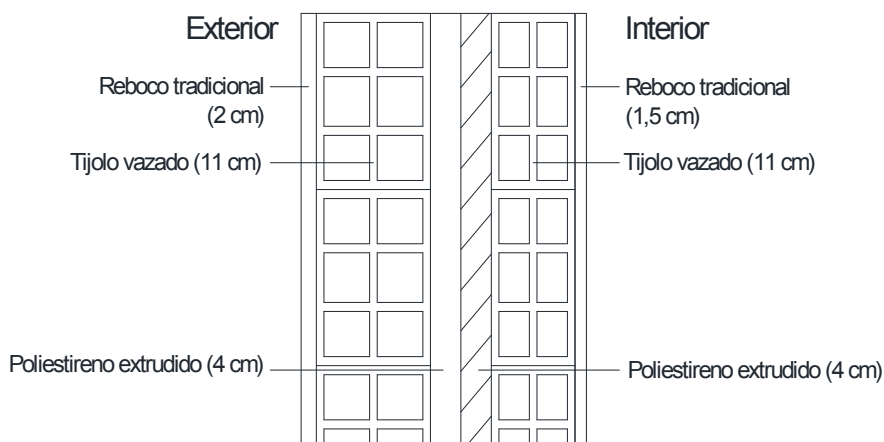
Parede dupla exterior em tijolo de alvenaria vazado.
